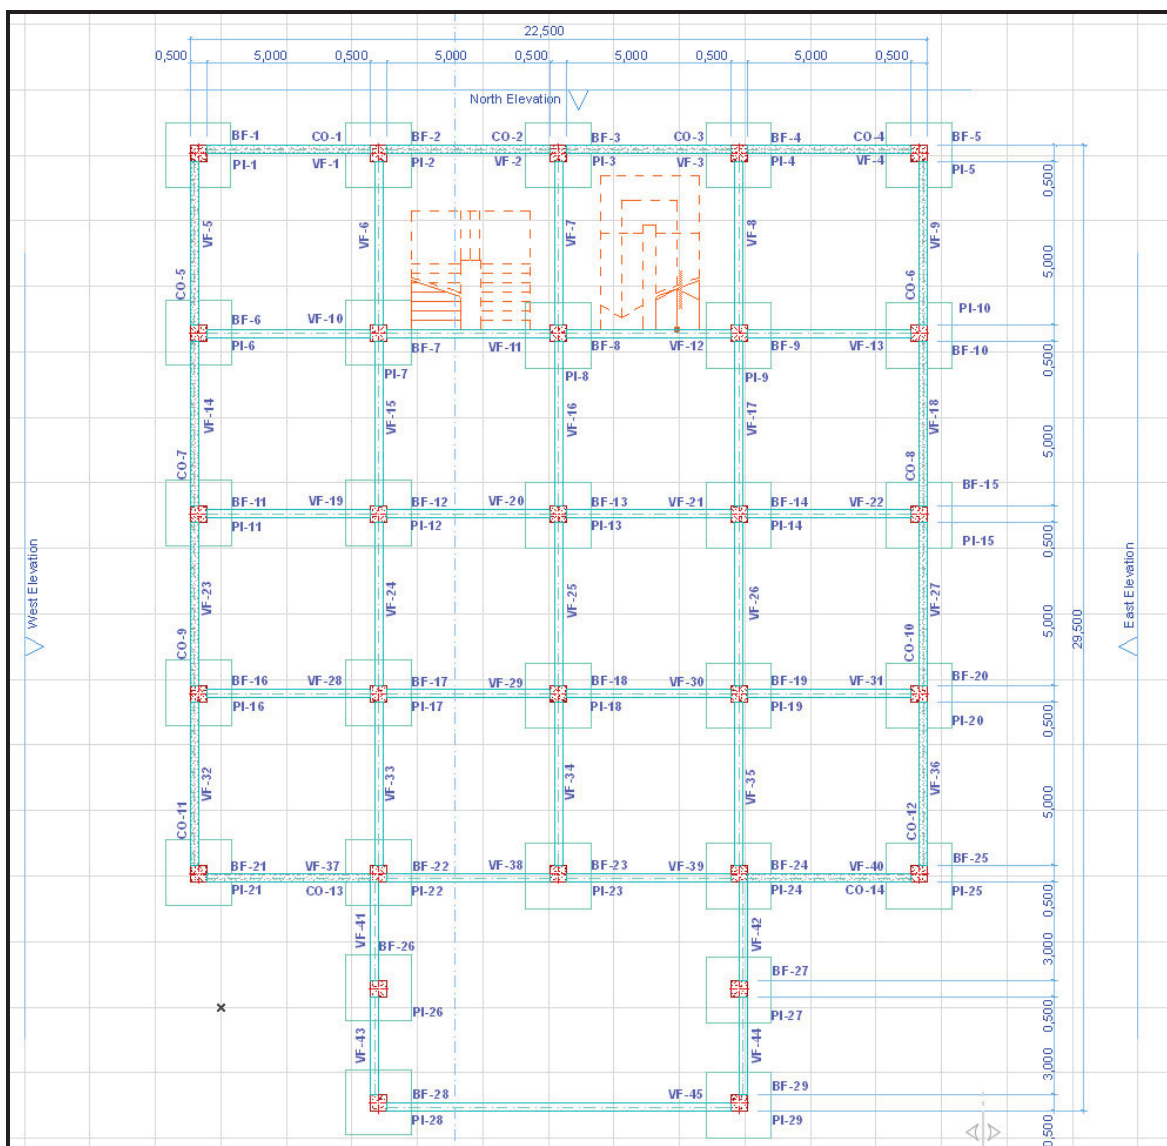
MODELO ARCHICAD 14 – PAVIMENTO TÉRREO
